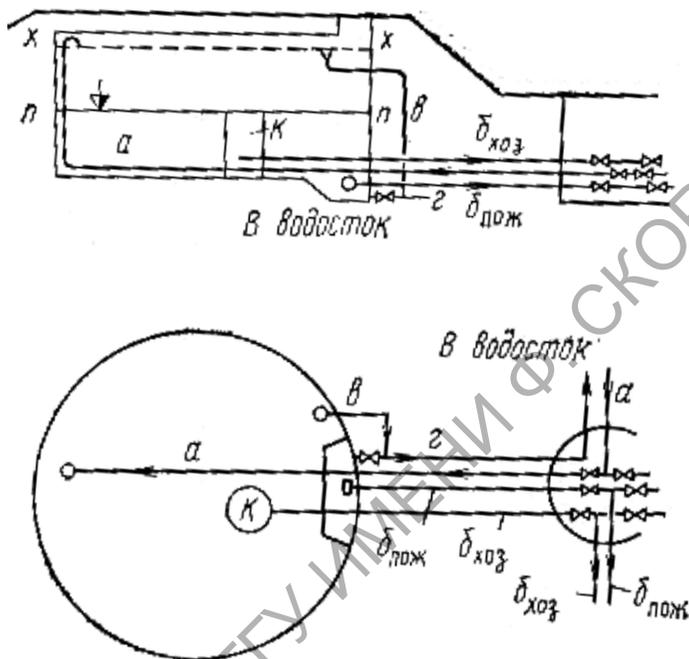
Схема коммуникаций для резервуара чистой воды:
